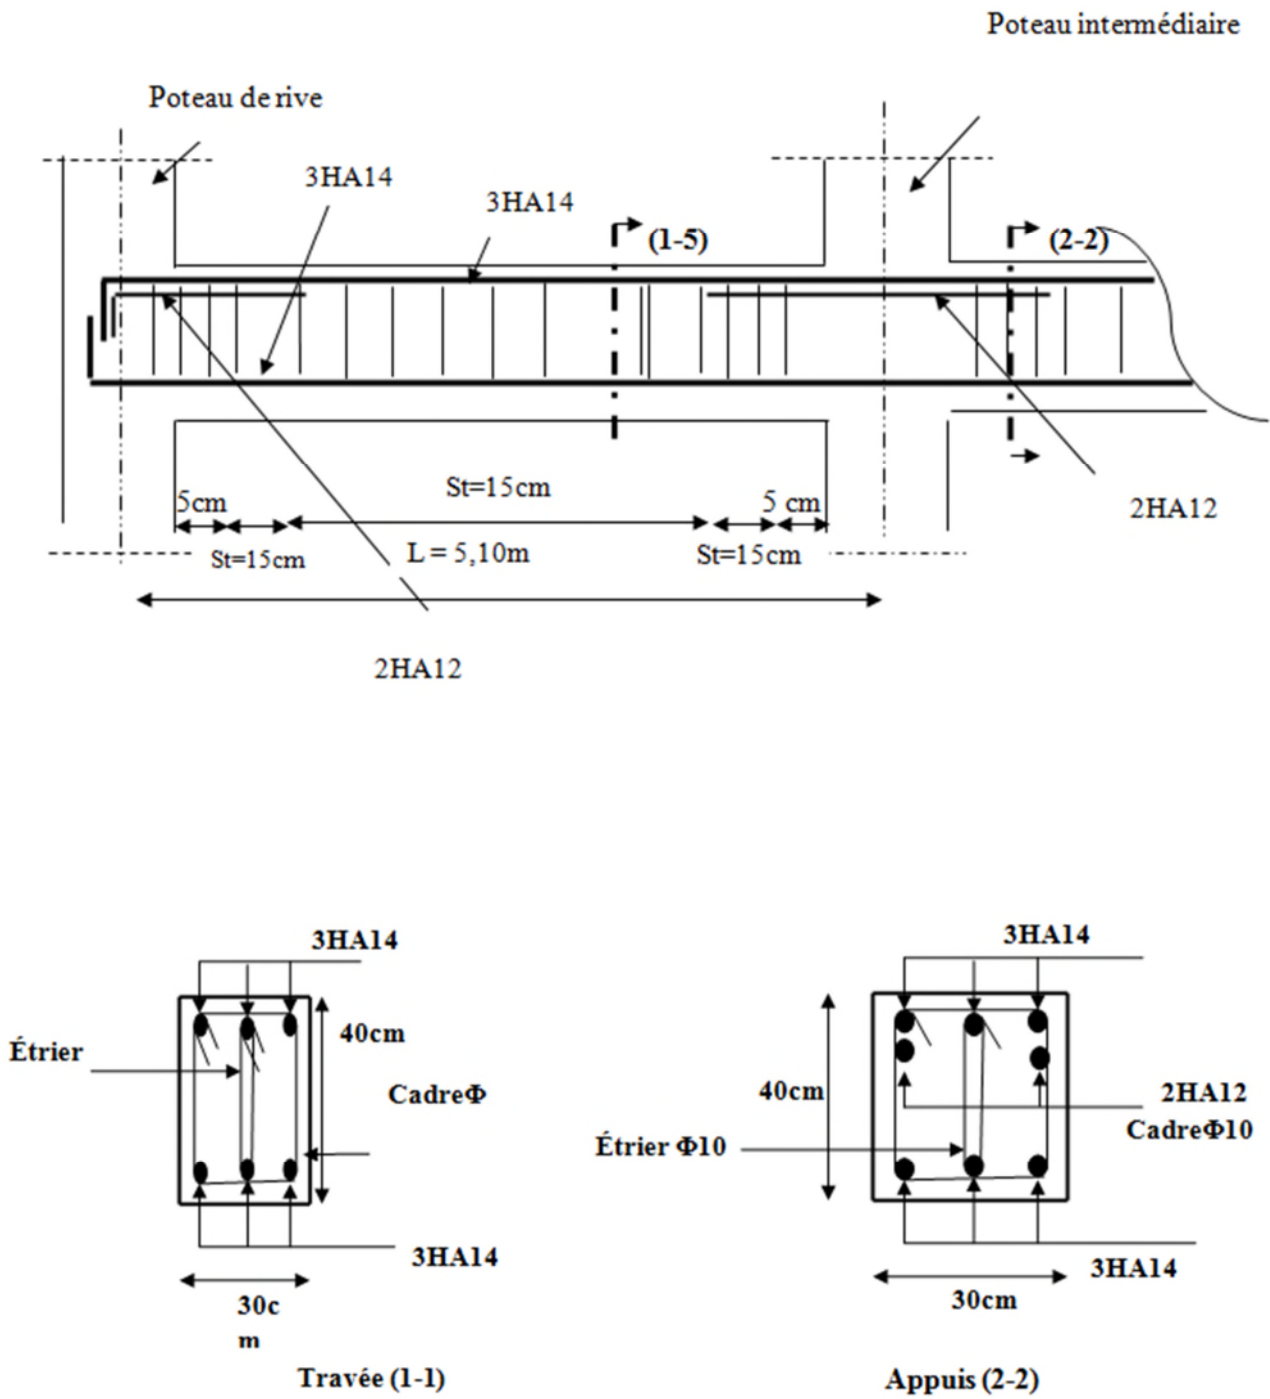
Schéma de ferrailage de la poutre principale (30*45) du 2^{ème} au 9^{ème} étage
